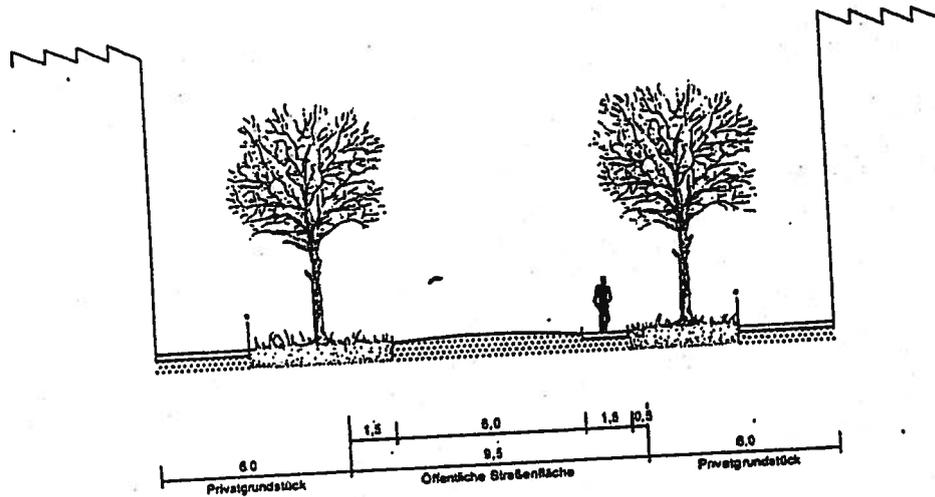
Straßenquerschnitt Planstraßen A, C, D
